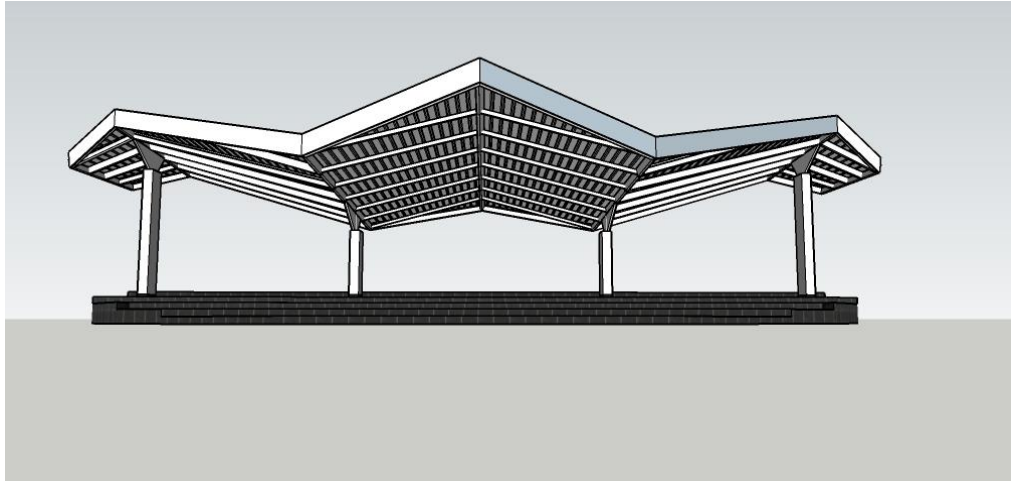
Modelo 3D Cubierta Campo de Parada vista desde abajo.
